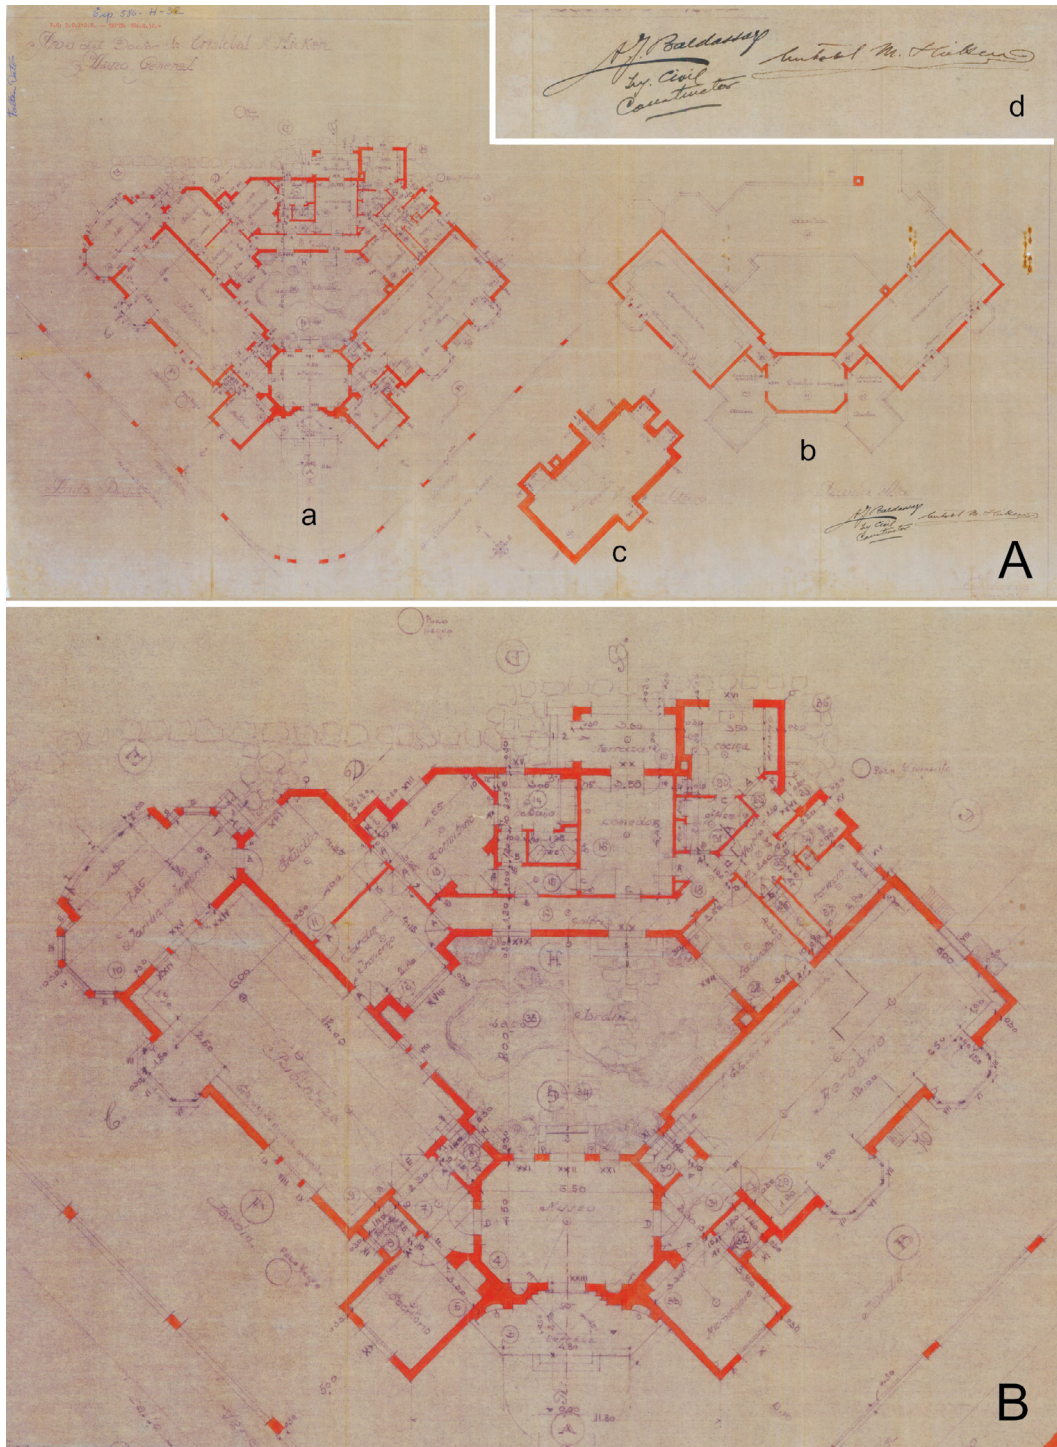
El Darwinion de San Isidro. Plano original de la planta del edificio. A, plano completo: a, planta principal; b, mezzaninos y altillo; c, sótano; d, firmantes de los planos (el Ing. Civil y Constructor Alberto. J. Baldassare y el Dr. Cristóbal M. Hicken). Nótese la orientación cardinal indicada entre a y c. B, detalle de la planta principal. Cortesía: Archivo de la Municipalidad de San Isidro.
